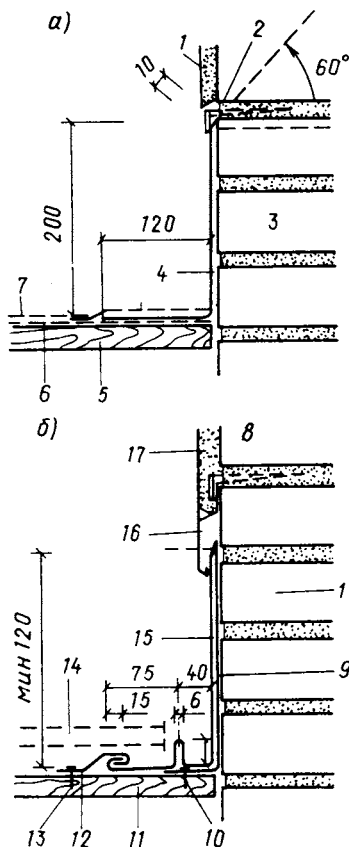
Фальцевое соединение надстроенных стен под битумную кровлю (а) и обшивка стен с отделкой под жесткую кровлю (б)
